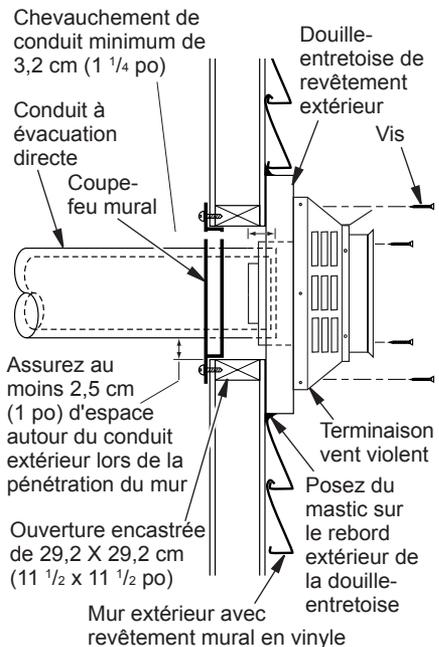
Montage typique de terminaison horizontale avec douille-entretoise supplémentaire
